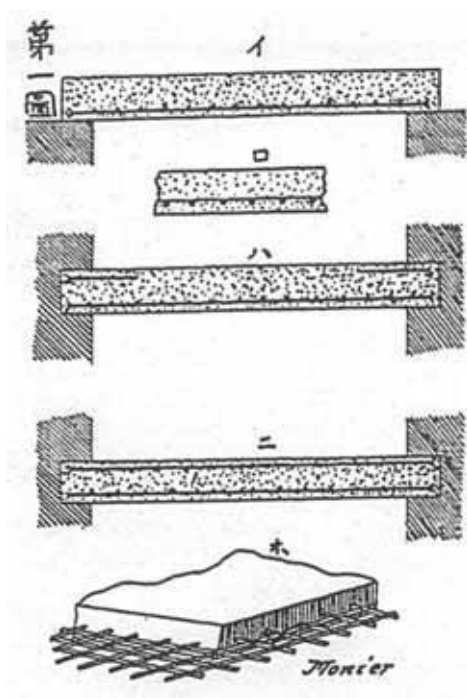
モリエ式平板の配筋図 (1878 年) ^{注10)}
